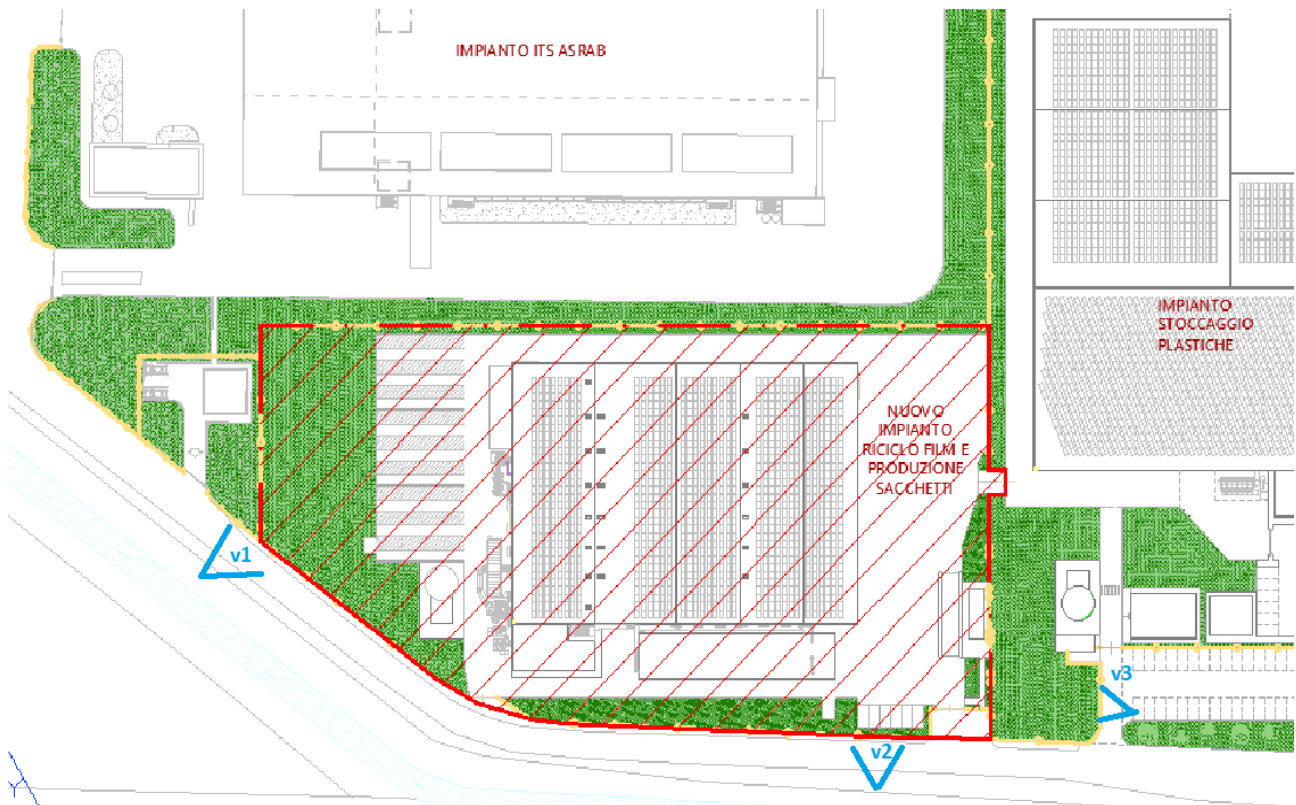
Pianta chiave documentazione fotografica dell'area d'intervento
